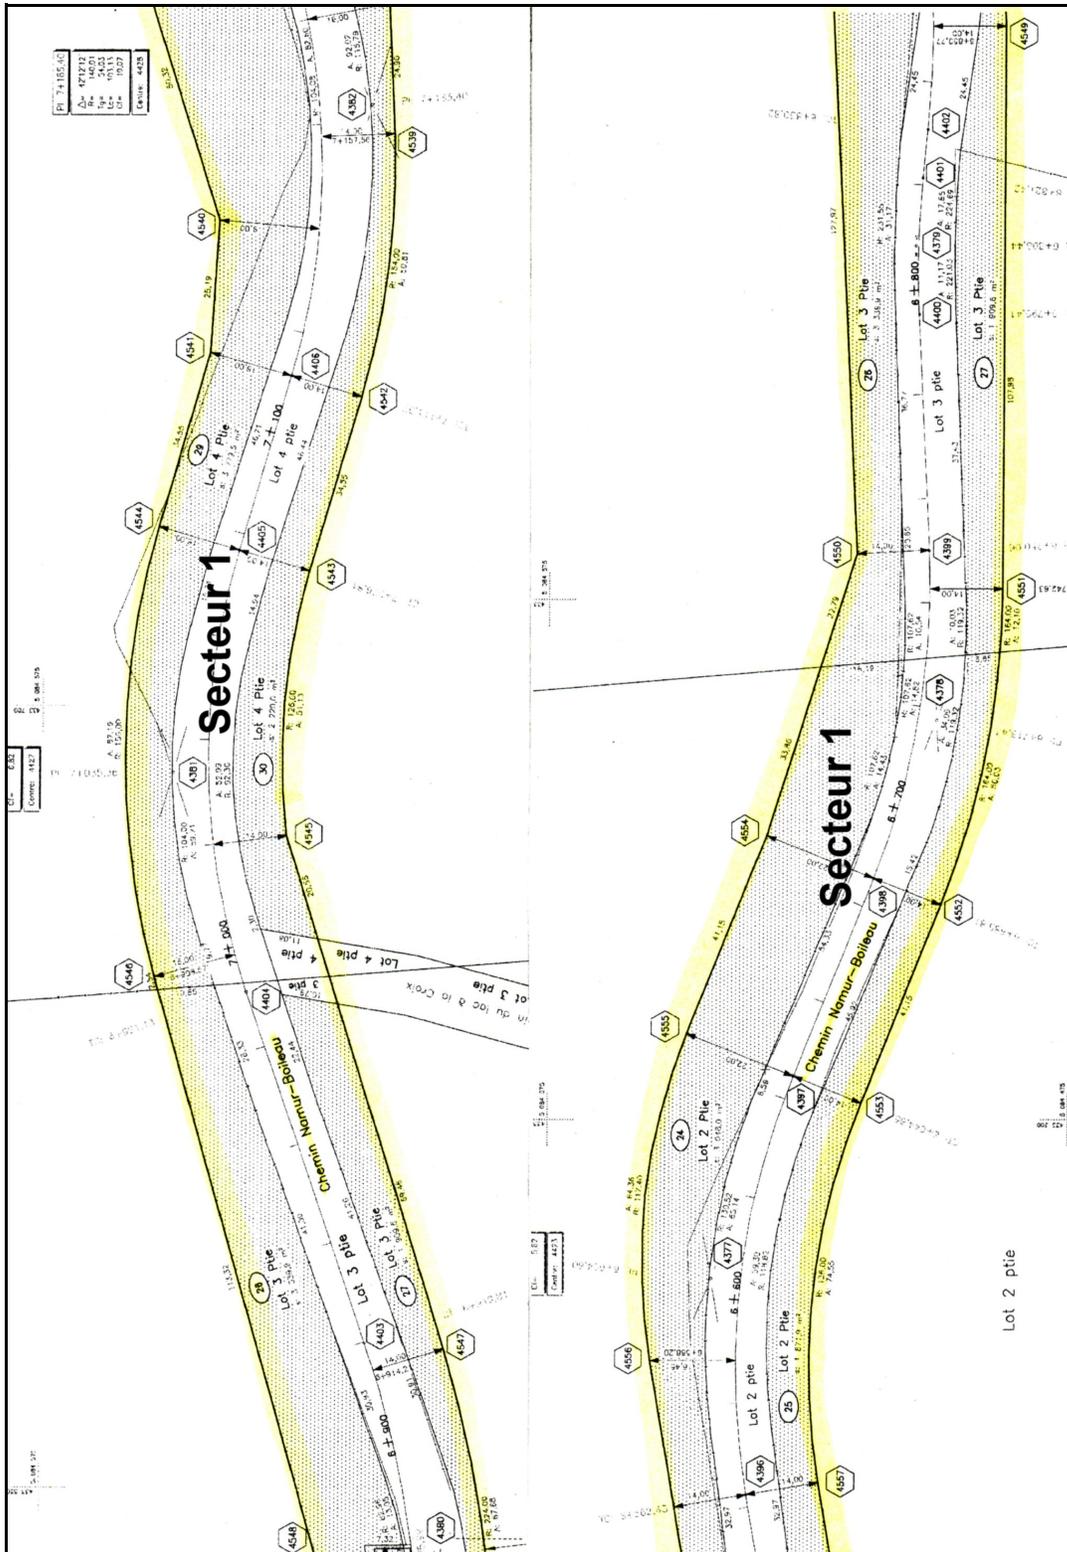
Localisation des secteurs d'inventaire sur le plan de construction du projet 20-6671-8035 (4/5)
